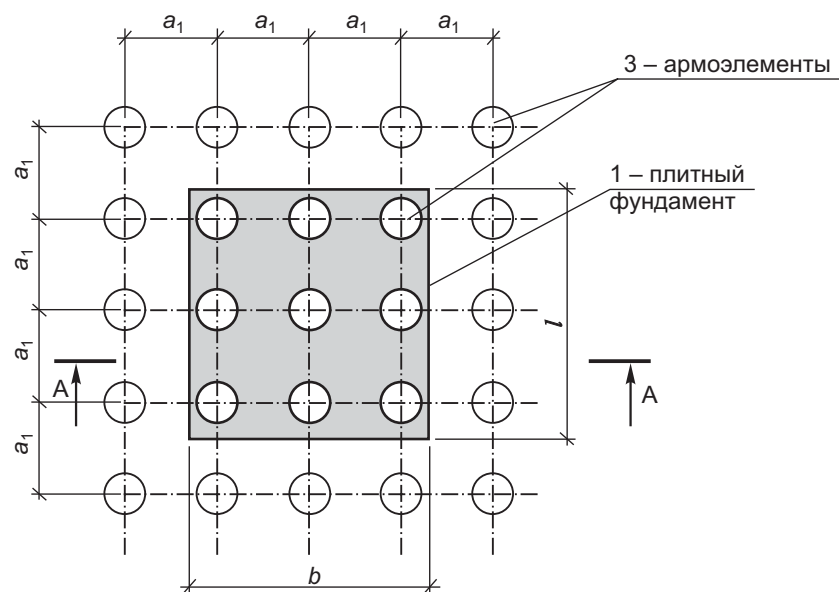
Расчетная схема на примере плитного столбчатого фундамента для расчета по второй группе предельных состояний
